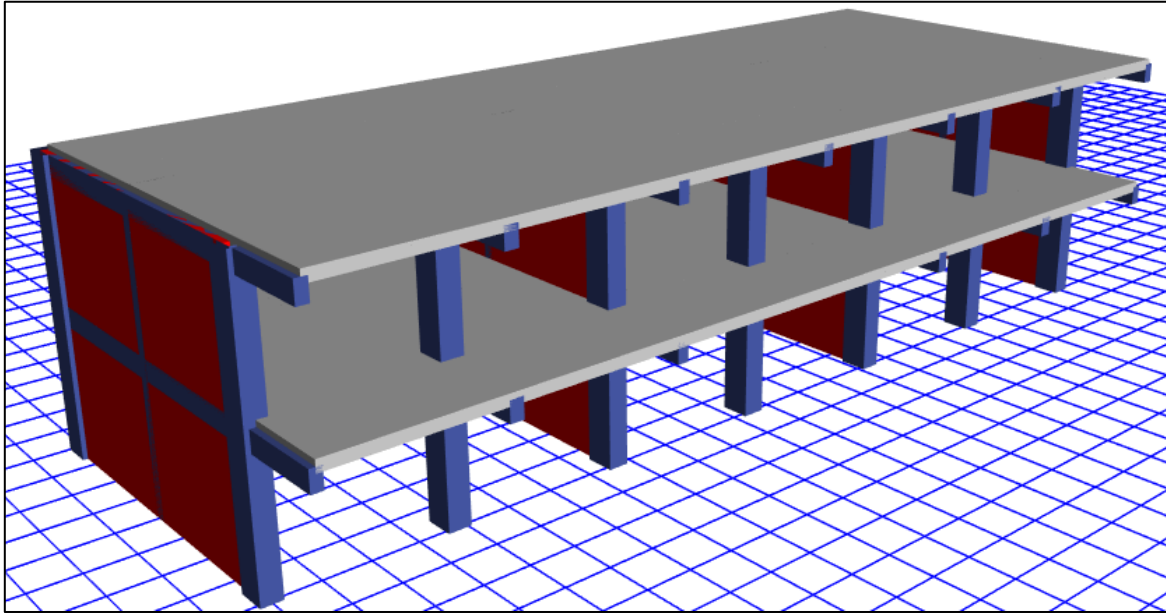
Vista en 3D del pabellón 2 reforzado.
